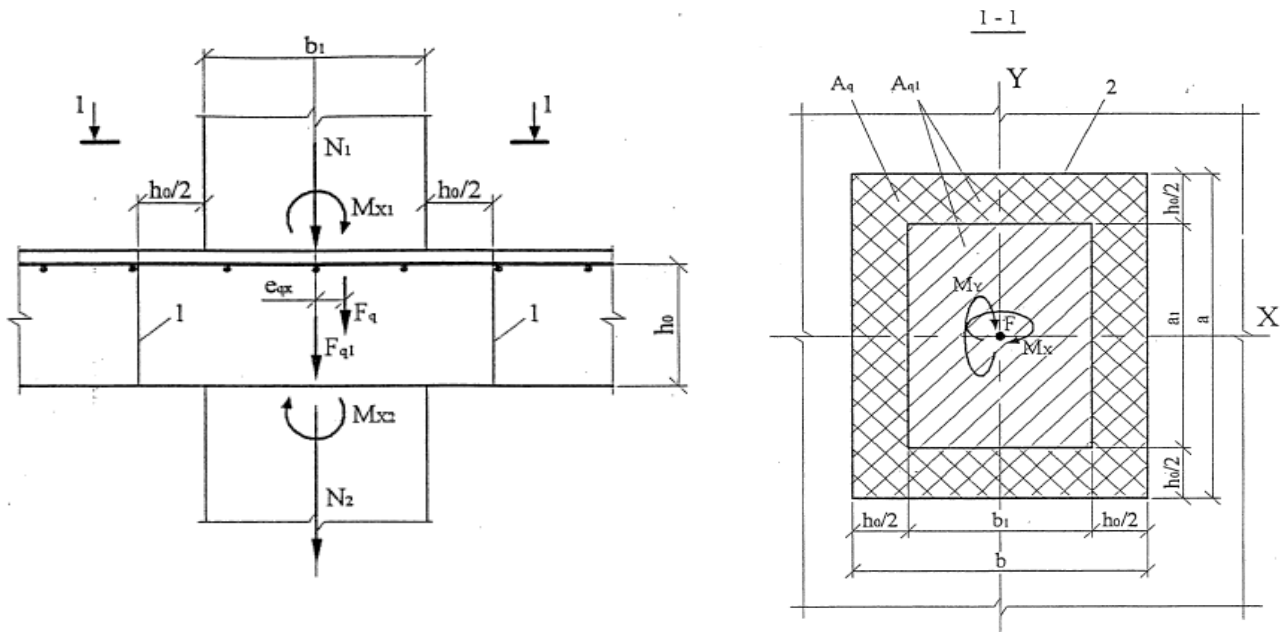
Расчетные схемы к расчету плиты перекрытия на продавливание.
